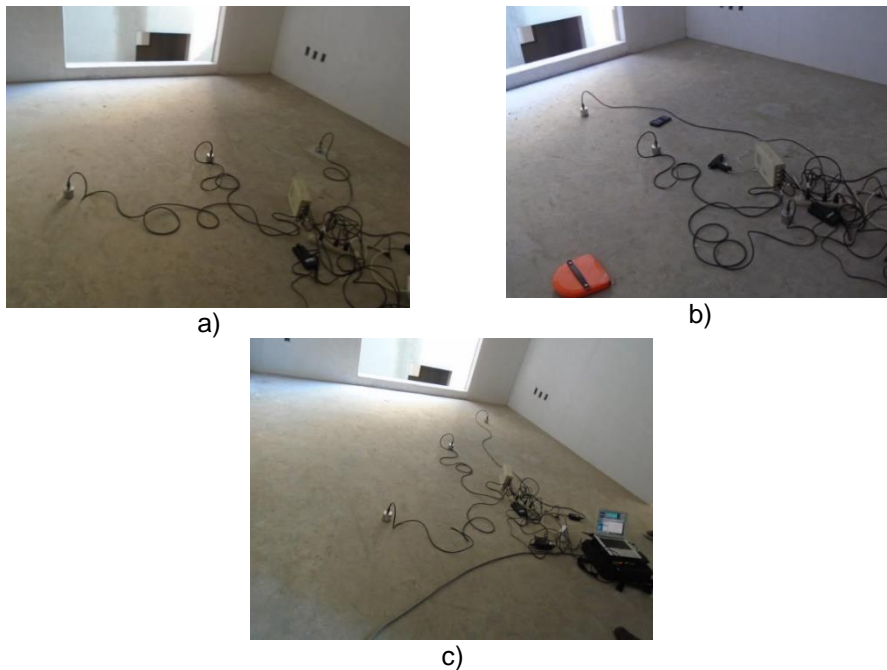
Sensores en la losa de prueba con arreglos: a) A1, b) A2 y c) A3
